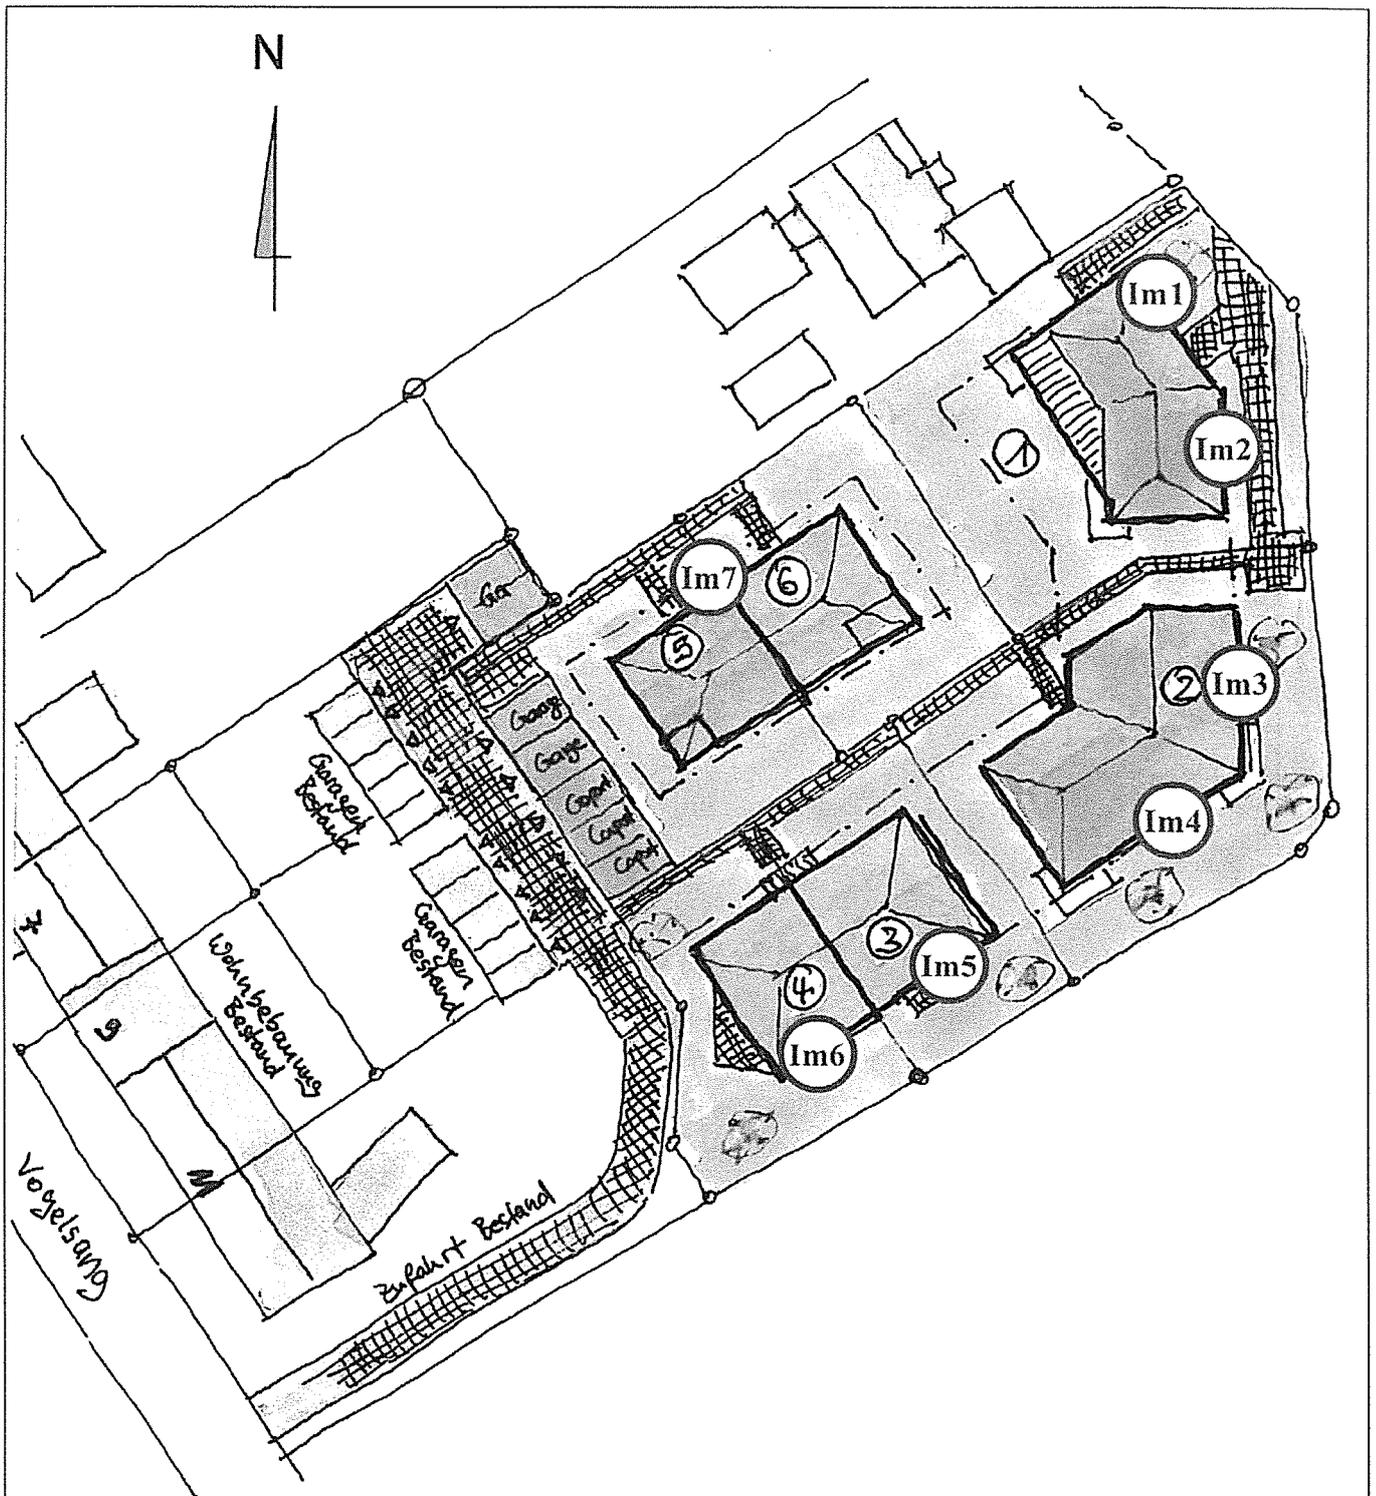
Vorentwurf der Gebäudeanordnung im Plangebiet mit Kennzeichnung der Immissionsorte.
